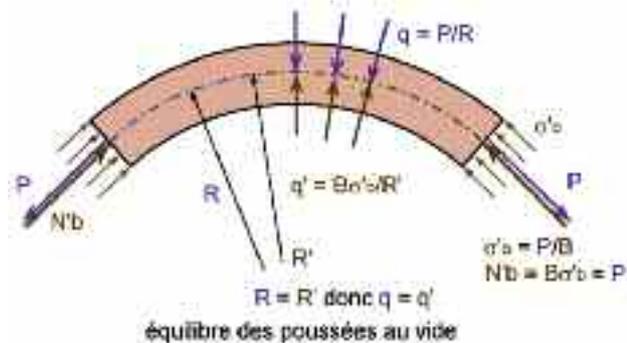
croquis explicitant les effets des poussées au vide dans une poutre courbe
